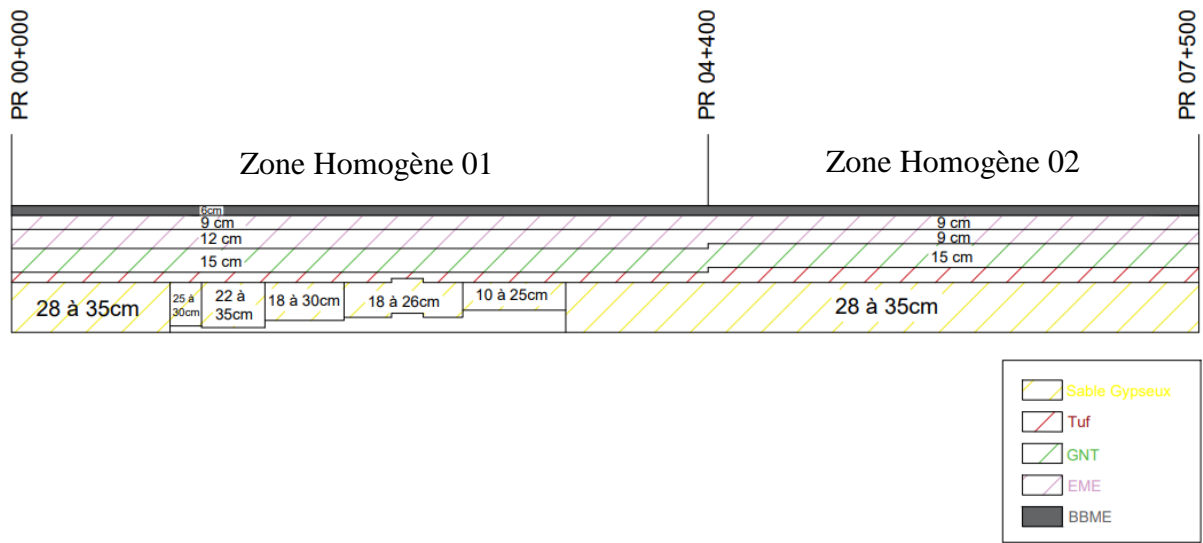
Dimensionnement de la chaussée BBME/EME–sens aller-.
